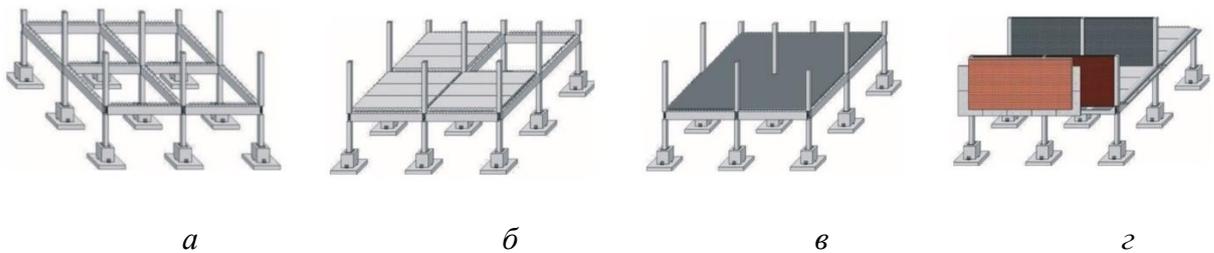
Технология сборки: а – возведение каркаса; б – монтаж плит перекрытия; в – бетонирование плит перекрытия; г – возведение перегородок и стен.
